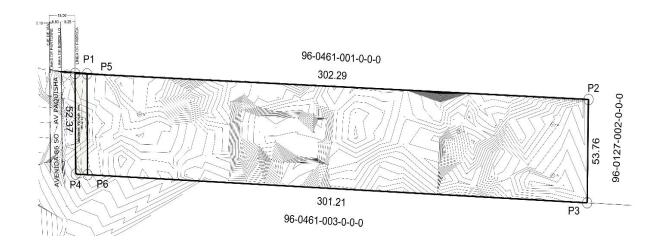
Plano Topográfico Altimetría y Planimetría del Proyecto Mirabella
